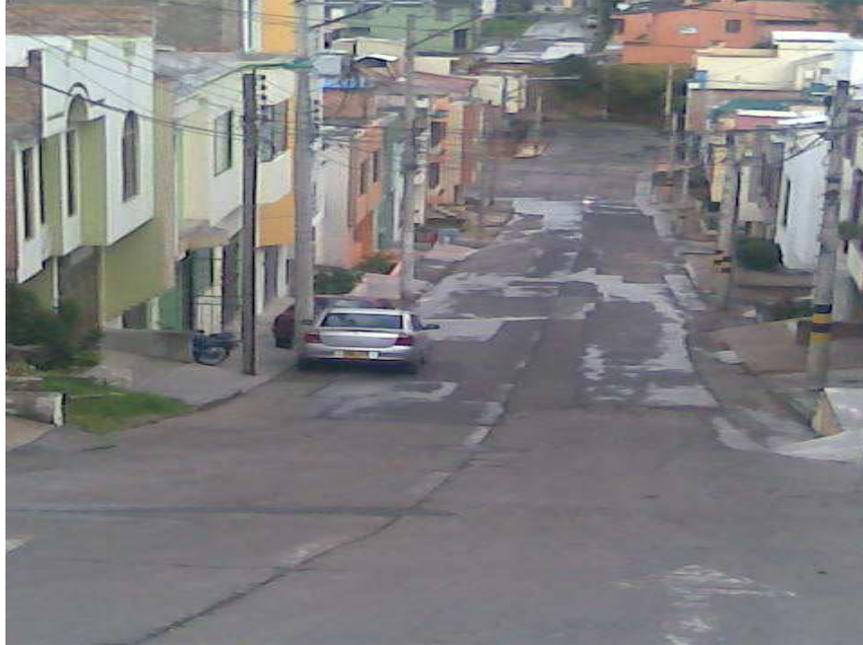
INSPECCIÓN DE CAMPO CALLE 12ª VILLAS DE SAN RAFAEL.
